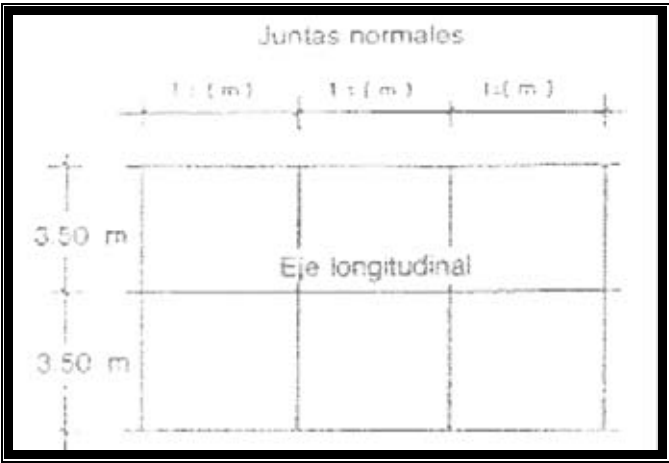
Junta Transversal de Contracción Normal
